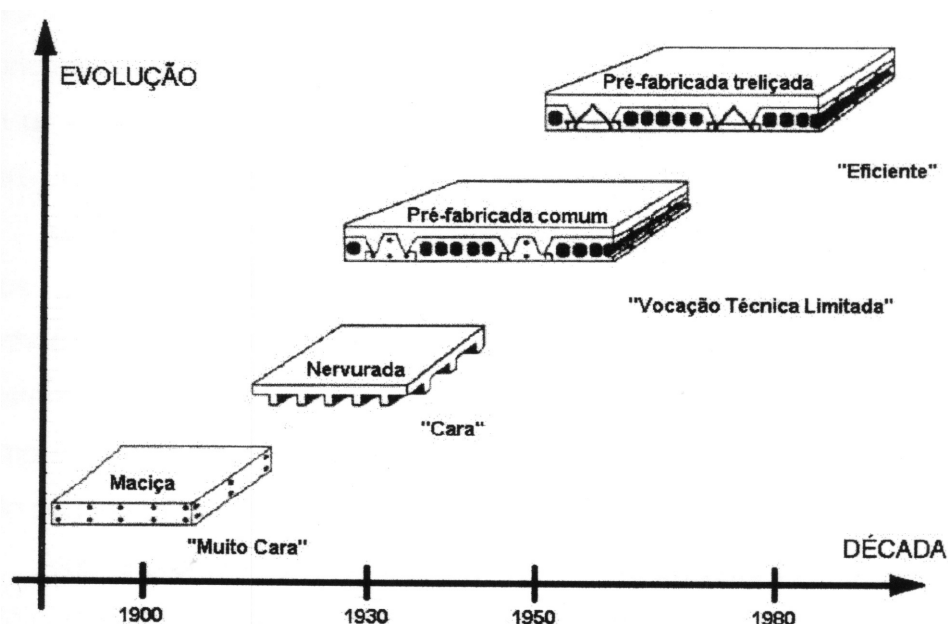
Evolução dos sistemas construtivos para lajes (Silva Filho, 2002)
